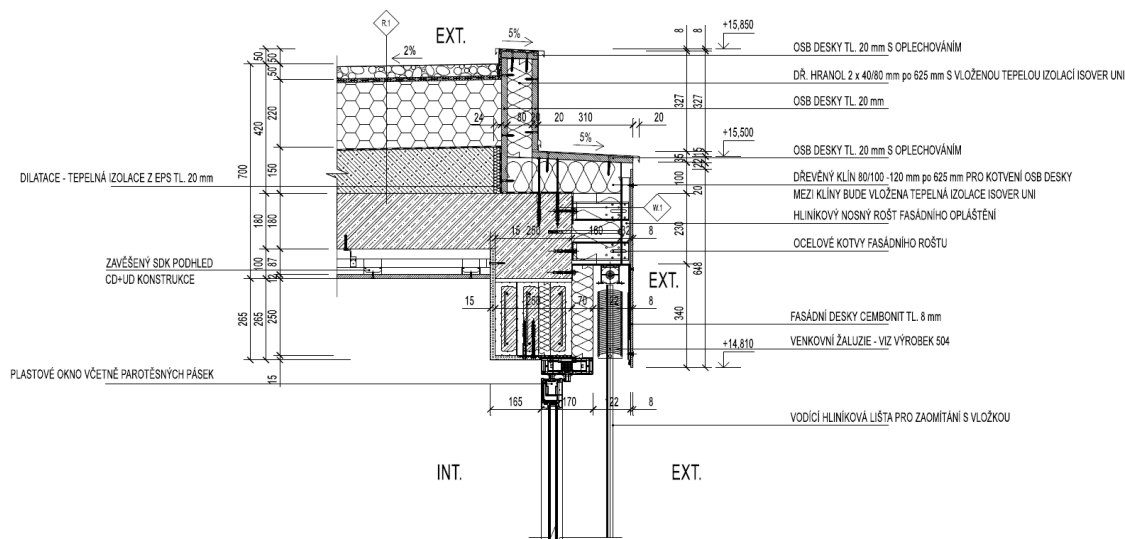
Detail 1 – Atika, terasa, nadpraží
